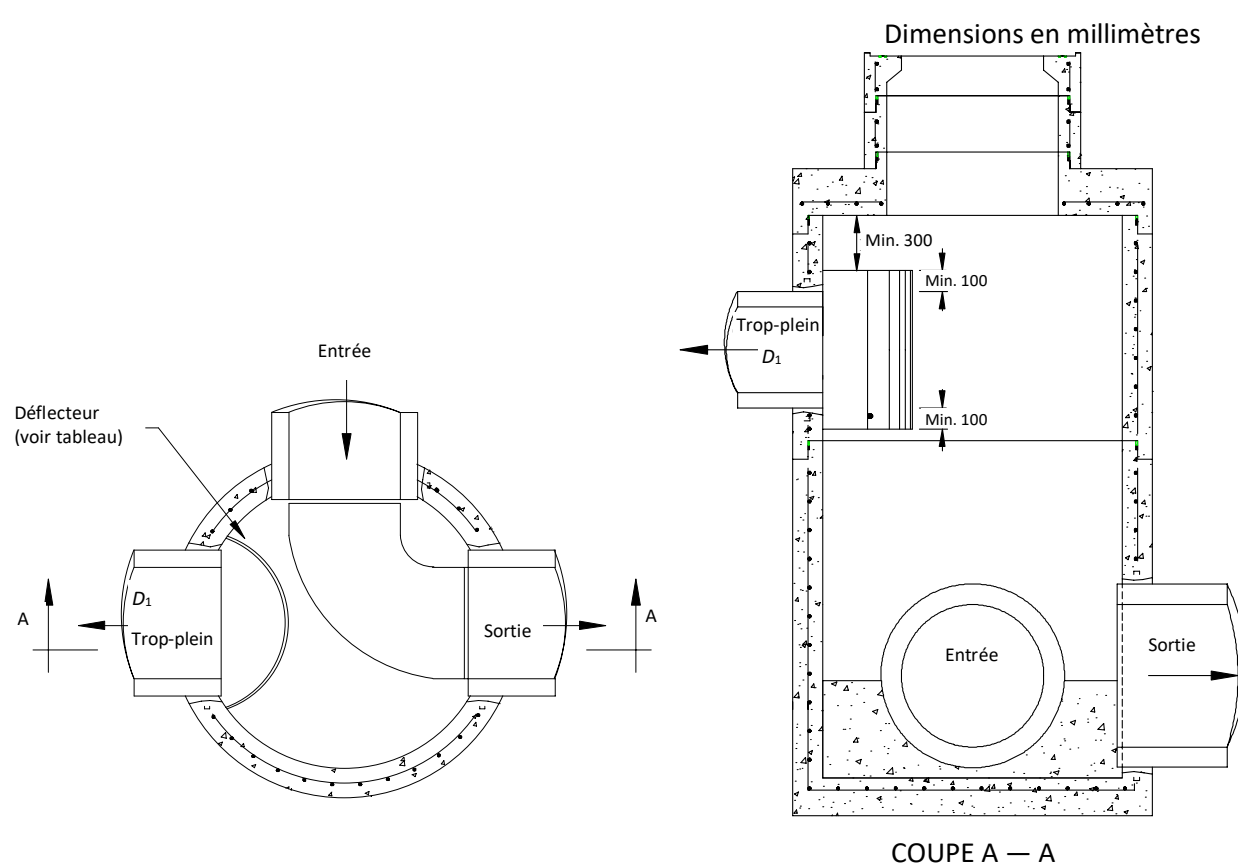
COUPE TYPE D'UN REGARD D'ÉGOUT AVEC CHUTE POUR CONDUITE D'ENTRÉE D'UN DIAMÈTRE NOMINAL $D_1 > 760$ mm (articles 5.15.1.5 et 6.3.15.4) [section 2 de 2]
